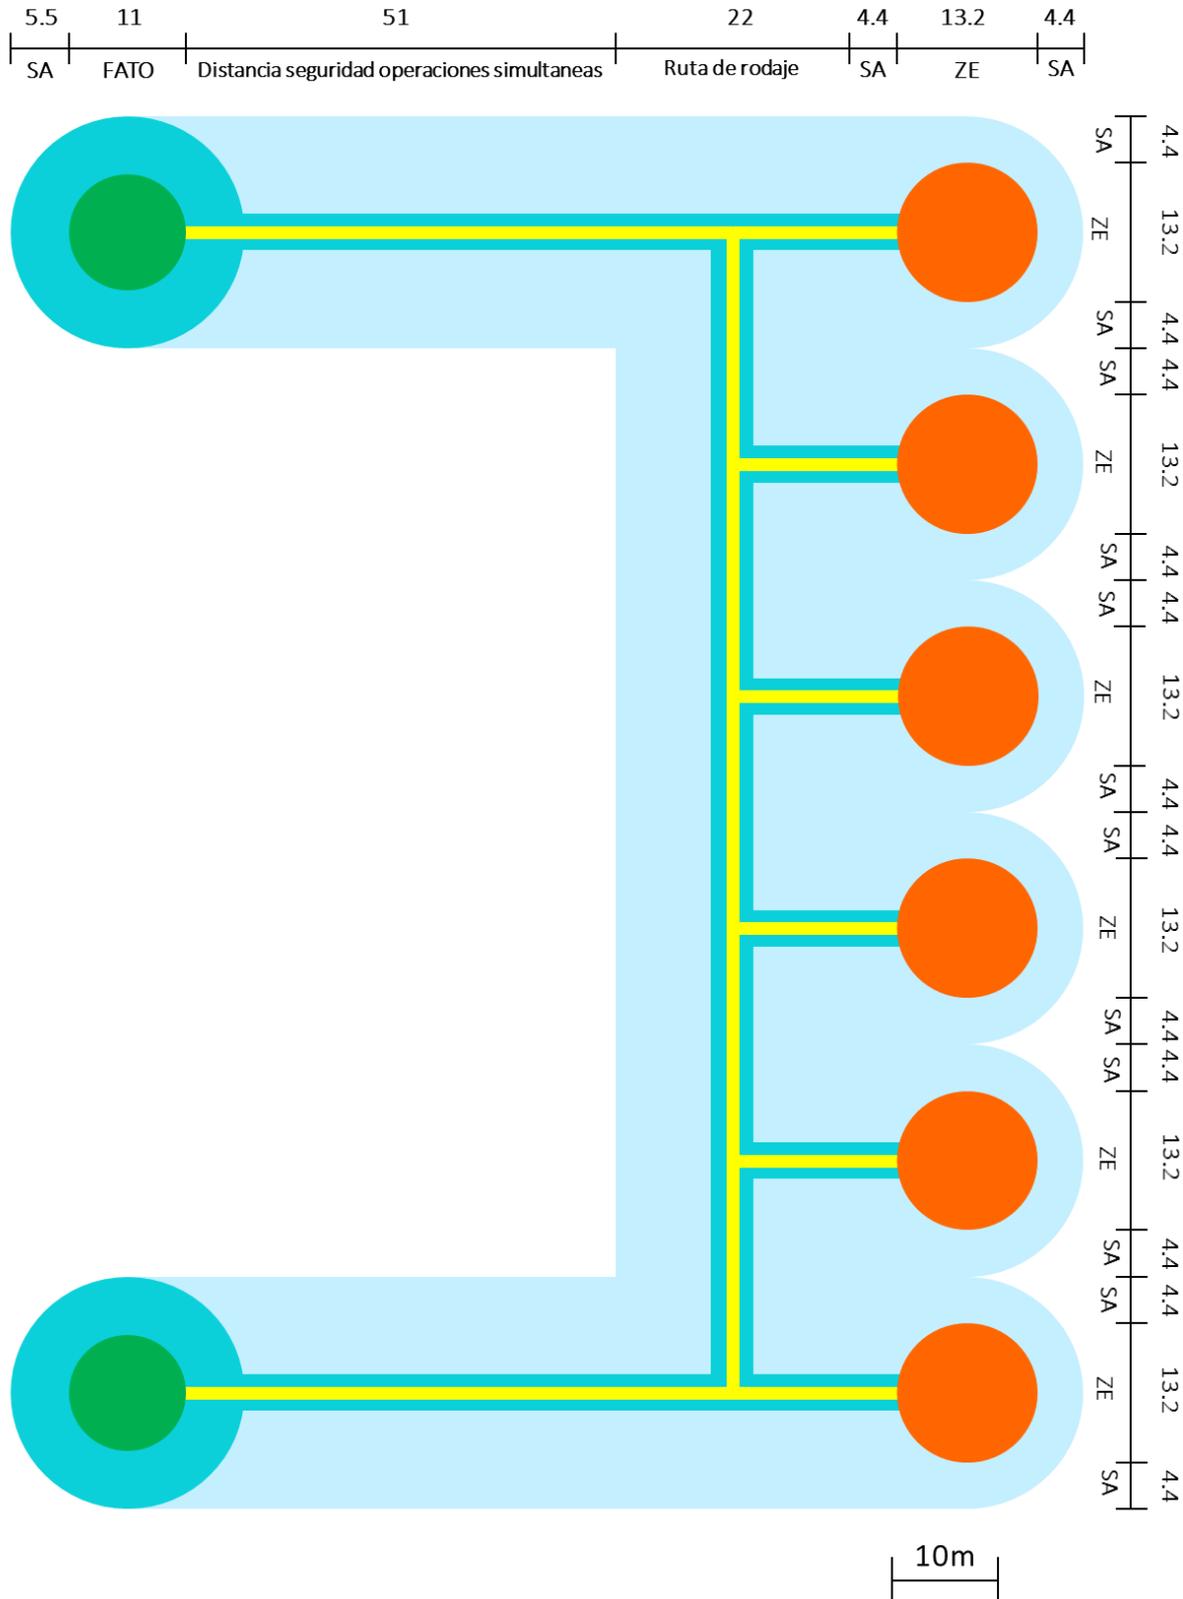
Plano dimensionado de la pista en configuración desacoplada. Fuente: elaboración propia, 2019
